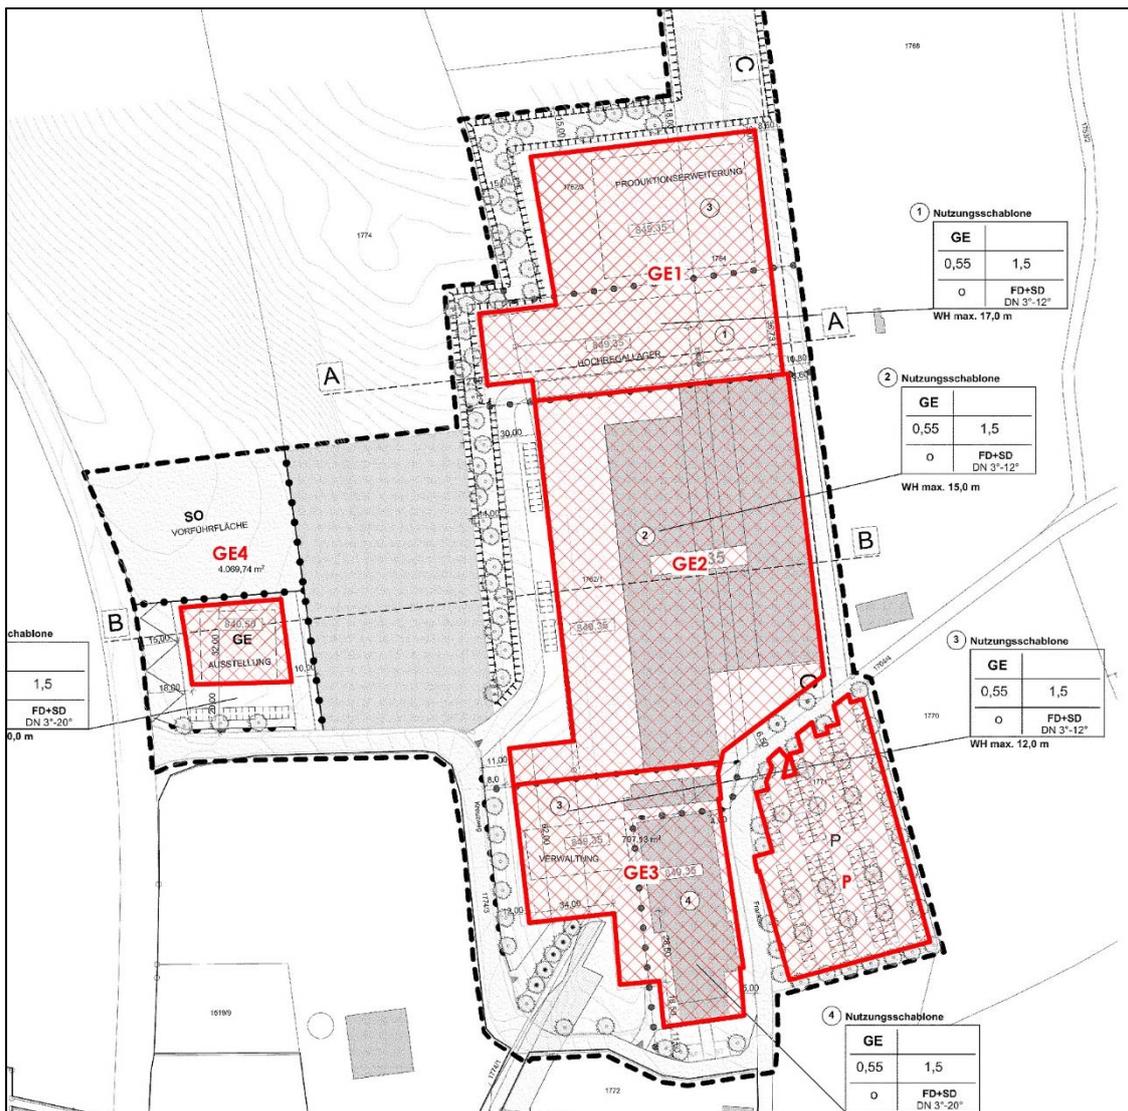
Lageplan mit Darstellung der schalltechnischen Gliederung des Plangebiets
